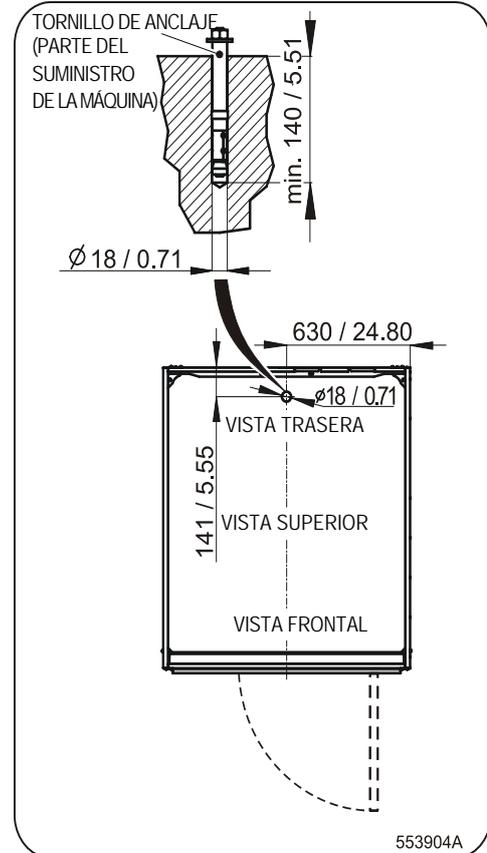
G Máquina 40-55 kg / 90-125 lbs con la inclinación delantera y sistema de pesado - punto del taladrado para el tornillo de anclaje, (dimensiones desde el capó de la máquina en mm / inch)
